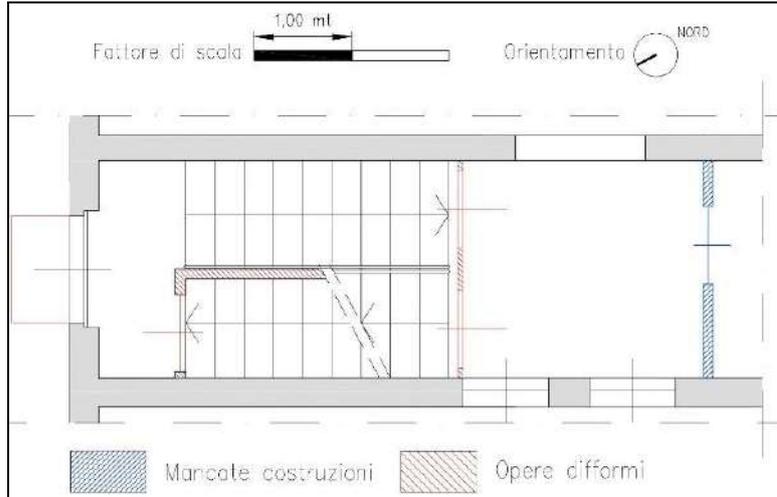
Pianta piano primo - confronto con la planimetria catastale ultima in atti
